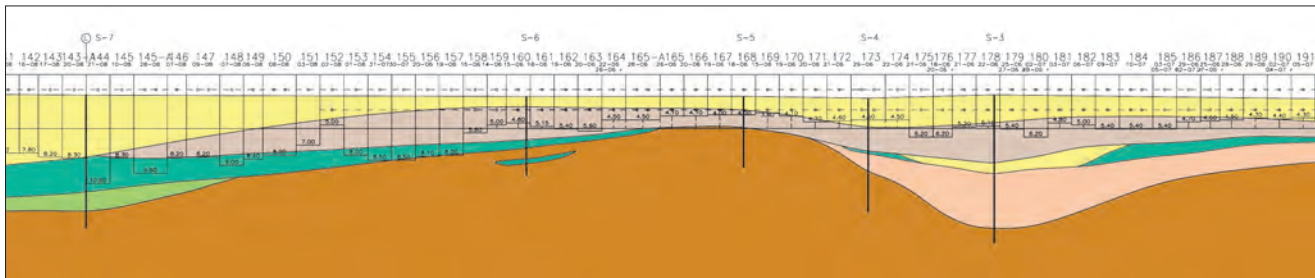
PERFIL GEOTÉCNICO LADO MAR ZONA 2: PANELES 138 A 193 (≈ 152 m).
